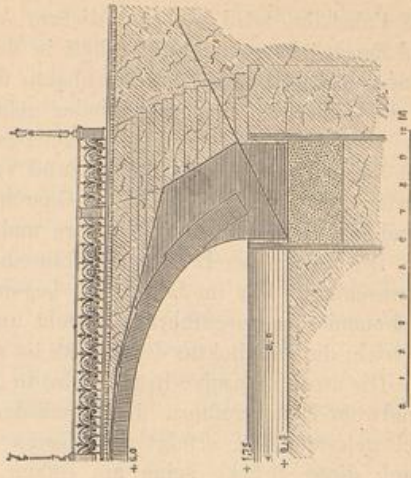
Hallesche Thorbrücke. (Ansicht und Längendurchschnitt.) (Maassstab 1:200.)
